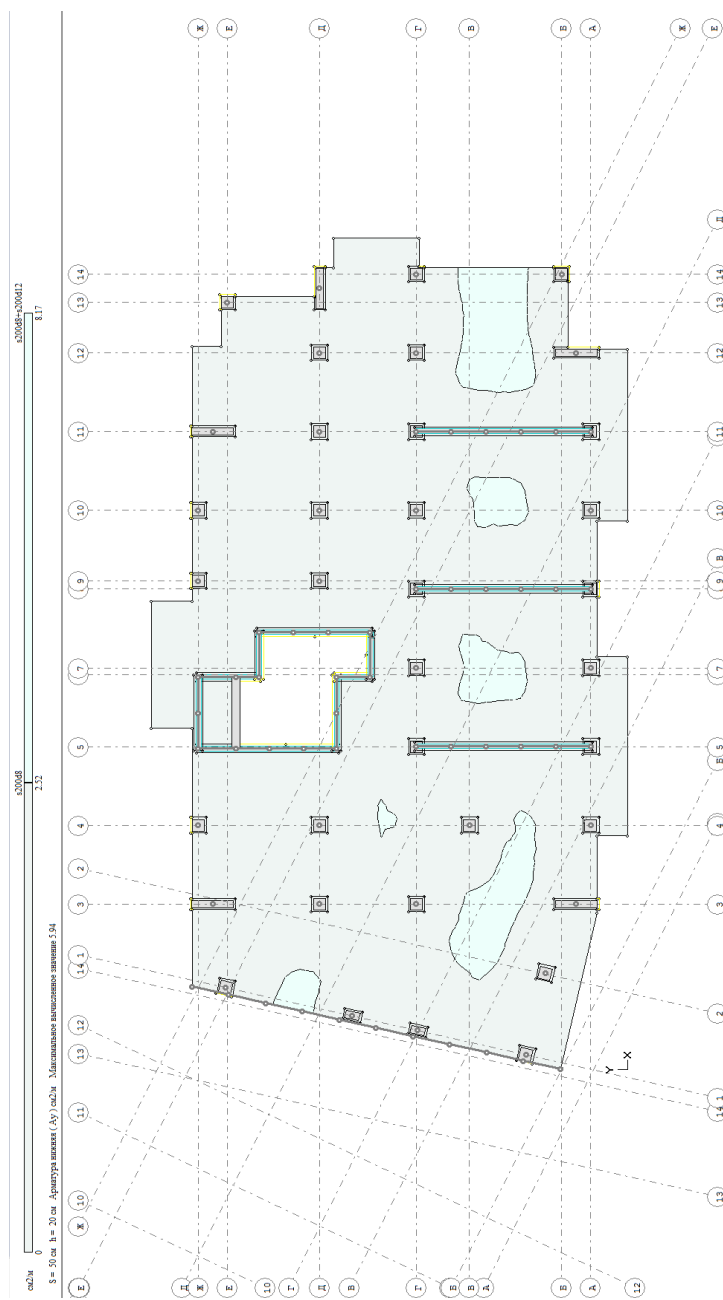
армирования плиты перекрытия типового этажа (толщина плиты 200мм, бетон В25)
